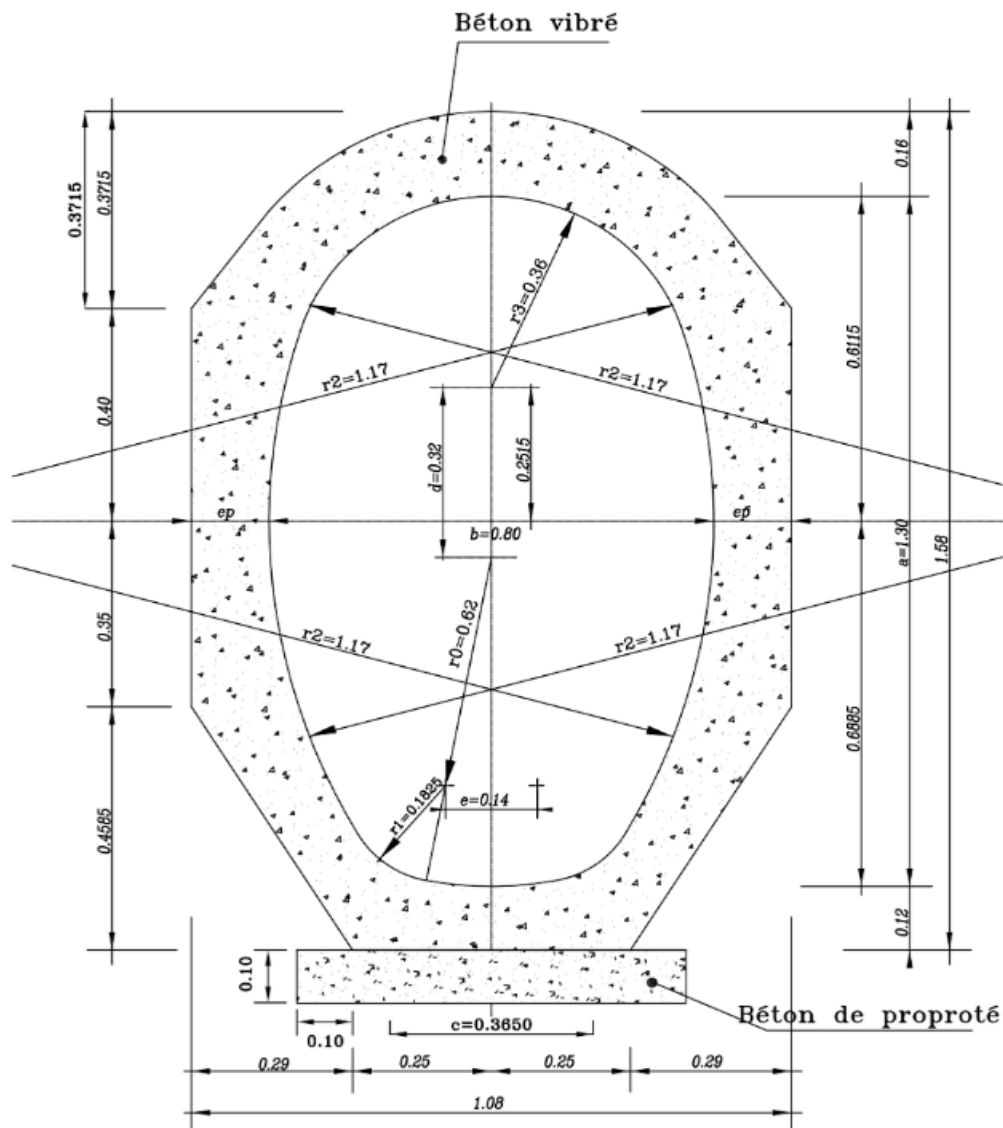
Coupe type d'une canalisation ovoïde préfabriquée
